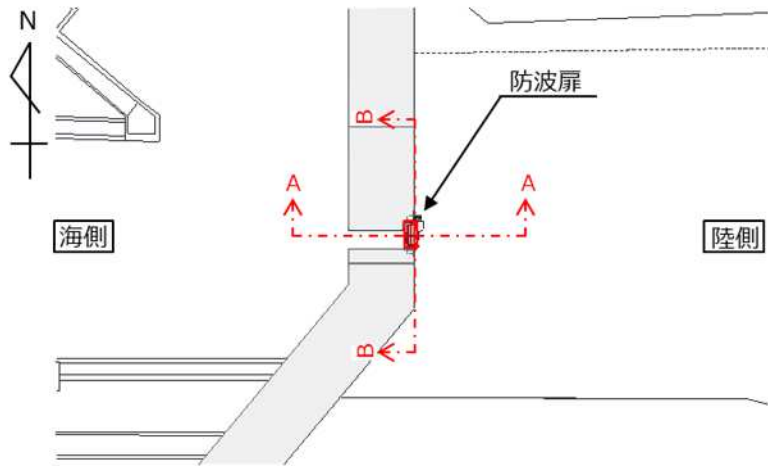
(1) 防波壁通路防波扉（1号機北側） 平面図
